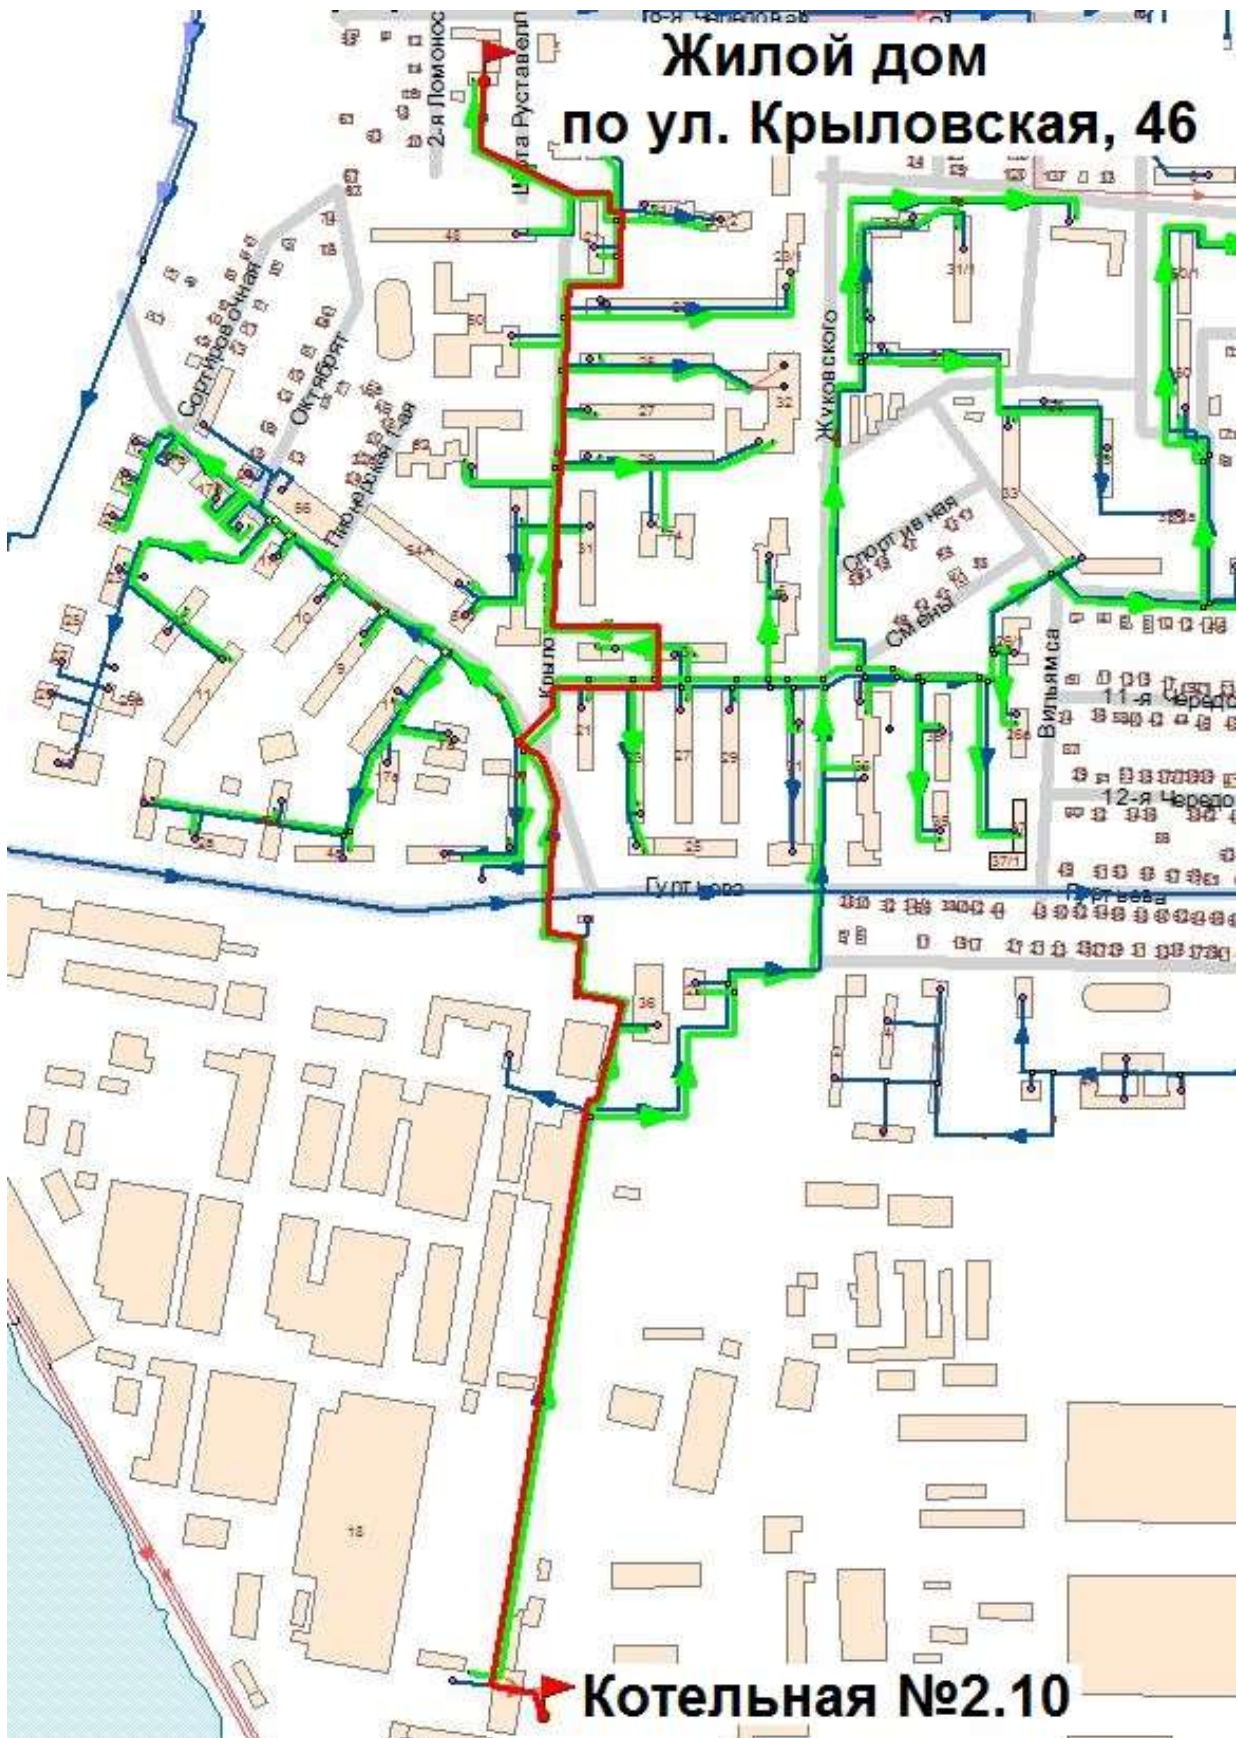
Трассировка теплопровода от Котельной 2.10 до жилого дома по ул. Крыловская, 46
